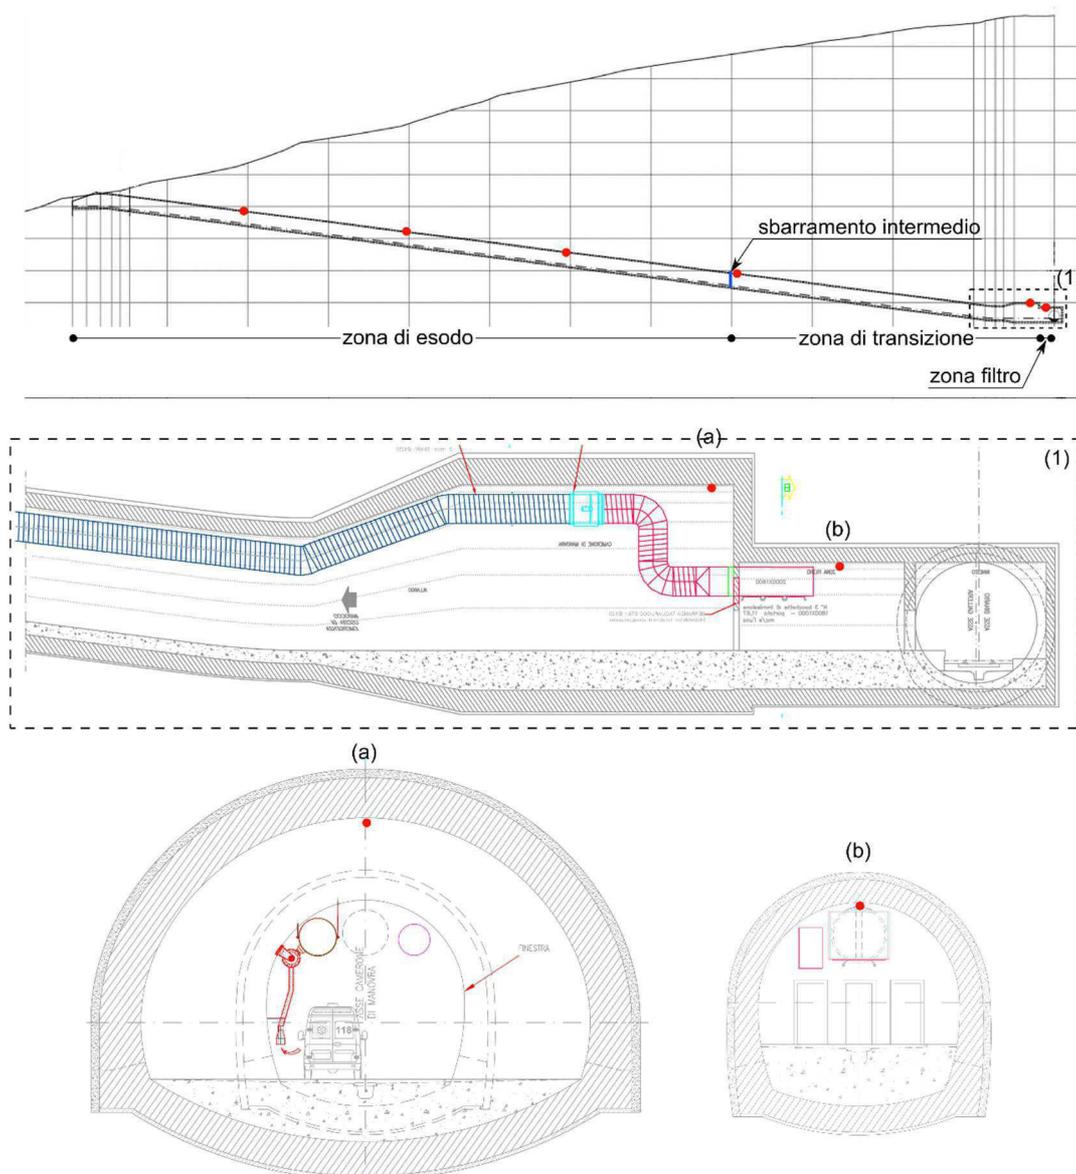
Tracciato altimetrico della Finestra e disposizione dei rilevatori IR (pallini rossi). Dettaglio del camerone e della zona filtro: sezione longitudinale (1) e sezioni trasversali del camerone (a) e della zona filtro (b).
